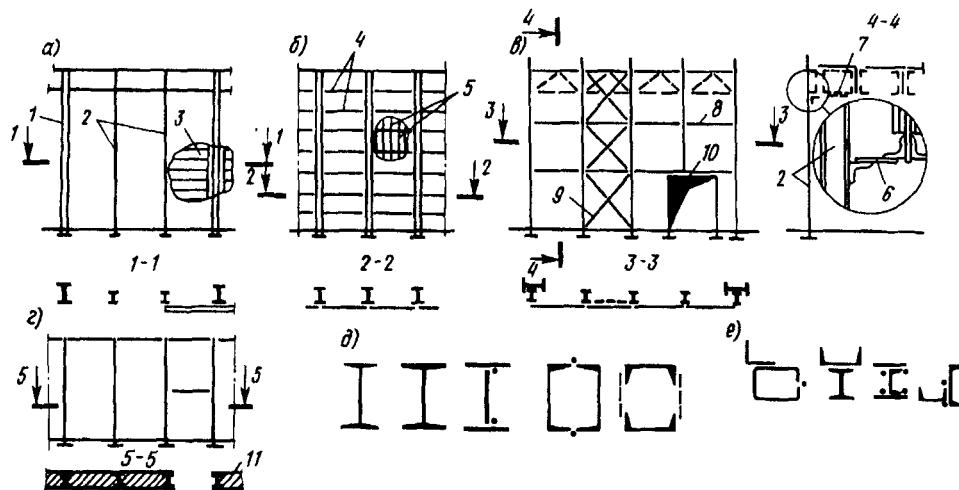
Схемы конструкций фахверка и сечения его элементов
